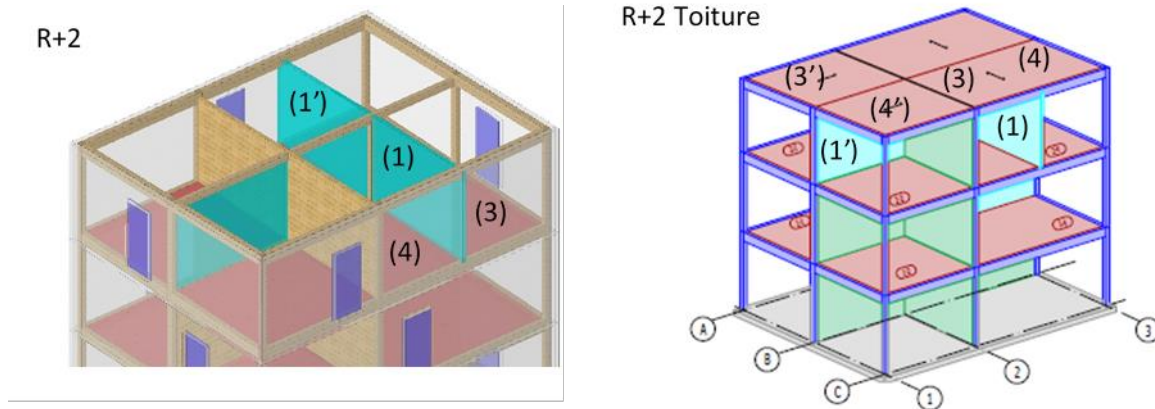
Vue des jonctions en T avec 2 planchers CLT et une SAD au R+2 (plancher bas et toiture).
